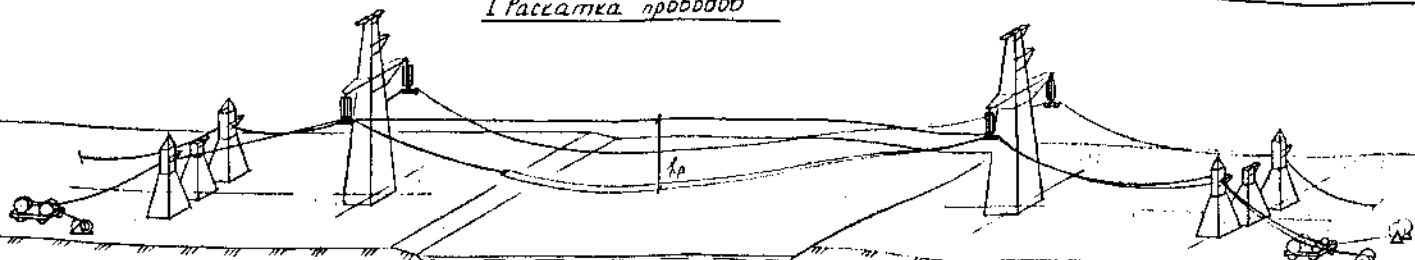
Схема расчета длин проводов, монтируемых методом отмера
